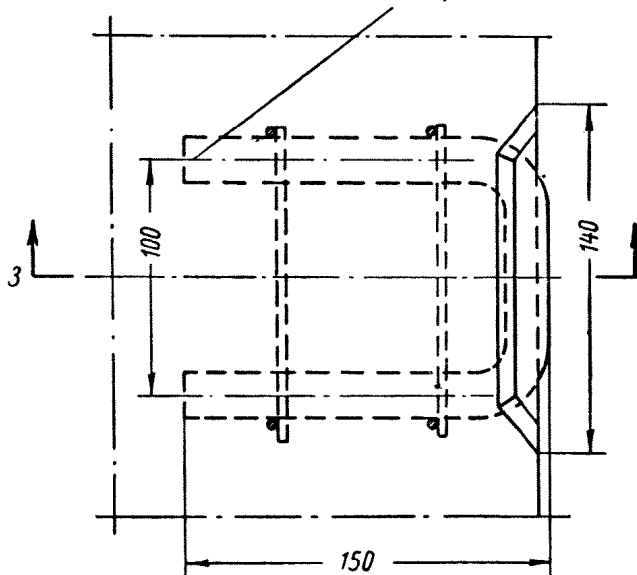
Конструкция стыкового соединения предварительно напряженных плит сборных покрытий
